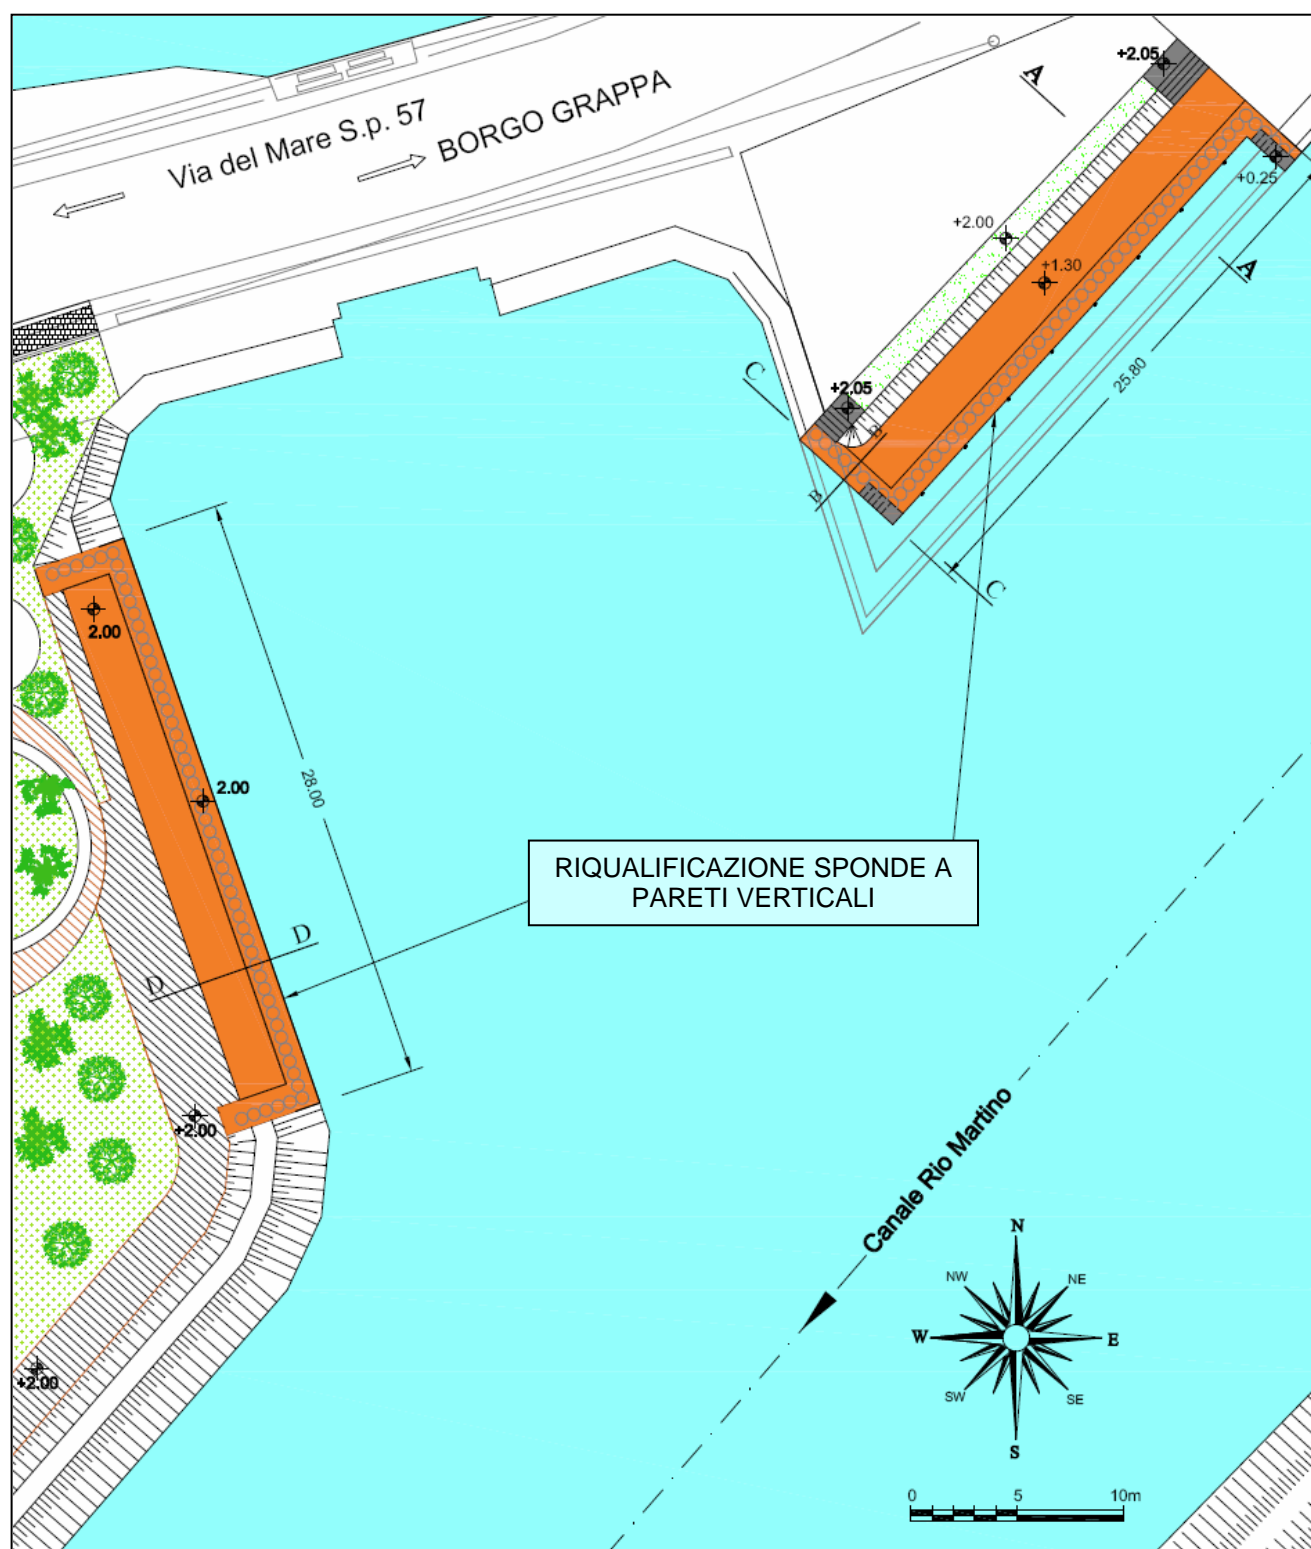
Tratti di sistemazione delle sponde con strutture a parete verticale banchinate
